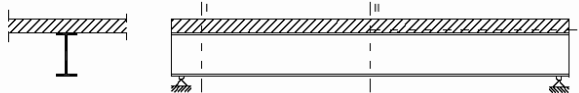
Trave d'acciaio con soletta collaborante
